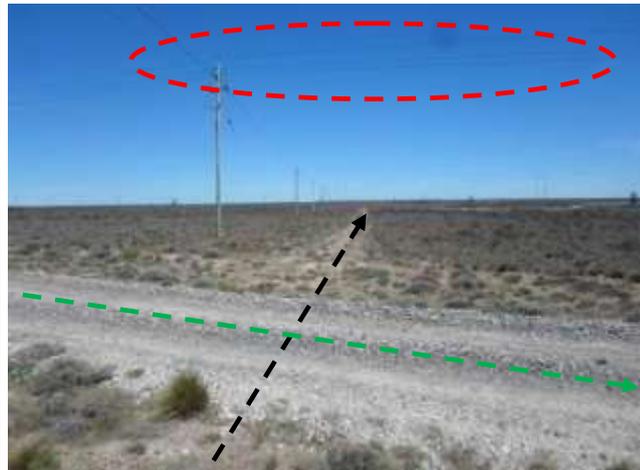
Emplazamiento de línea de inyección por picada (negro). Cruce con camino (verde) y línea eléctrica (rojo). Foto en dirección O.
